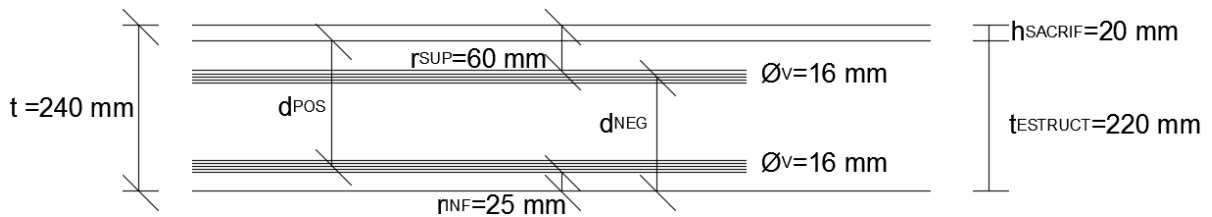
Alturas efectivas para el armado del tablero. Realizado por: Autor
